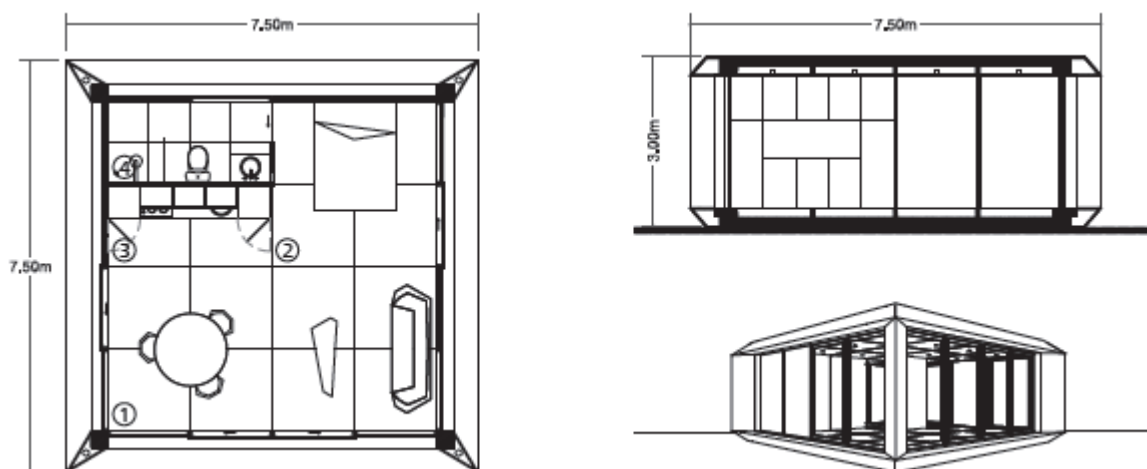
Planta e corte da casa MIMA (MIMA, 2012a)
